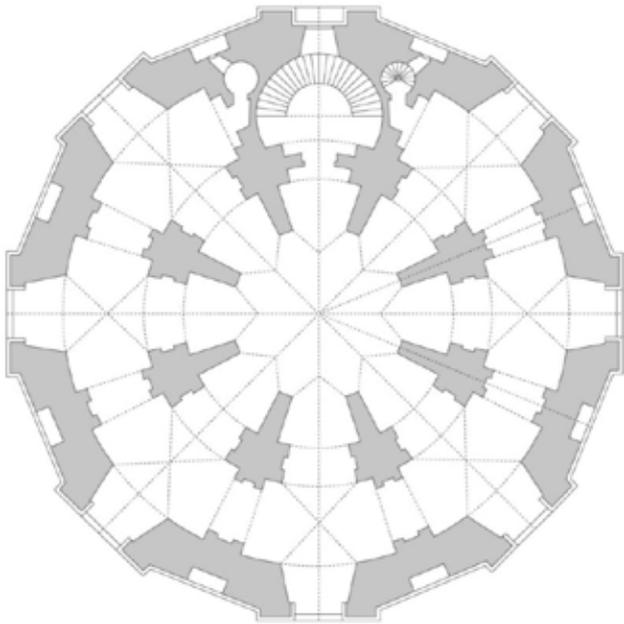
Grundriss der Rotunde von Radcliffe Camera, 1749
